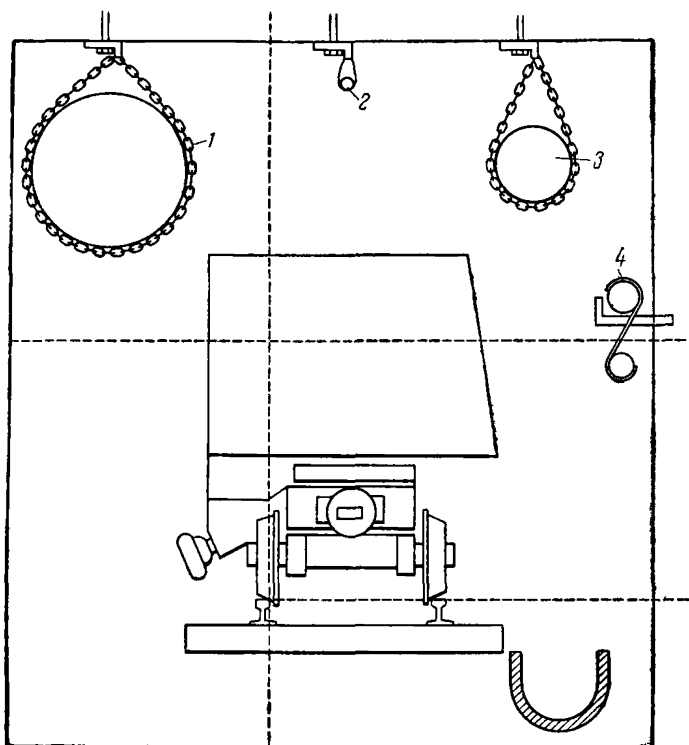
Типичная схема размещения оборудования в выработке при комбинированной схеме (всасывающей и нагнетательной) вентиляции (с перекрытием):
